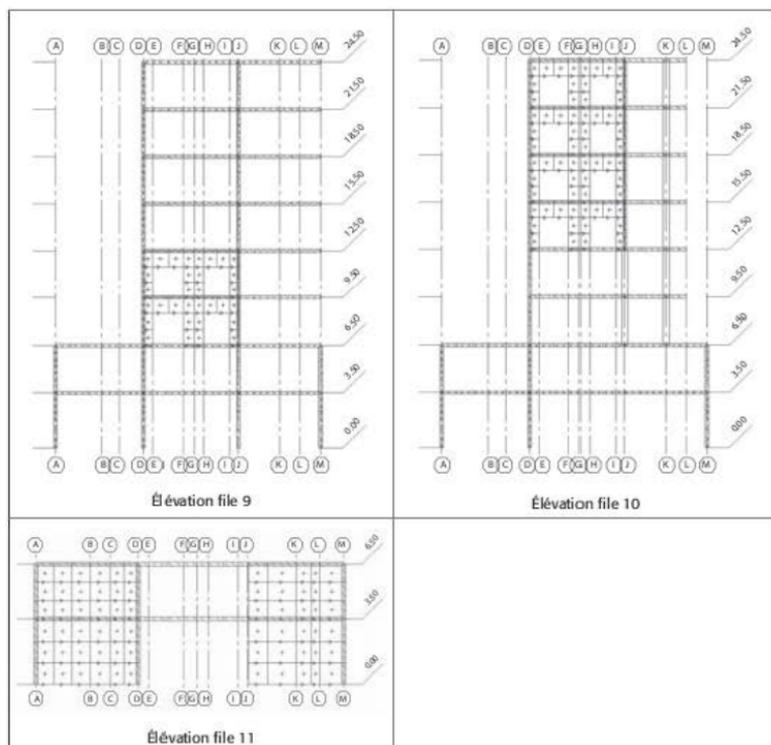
Élévations des voiles – plan YZ (3/3)
